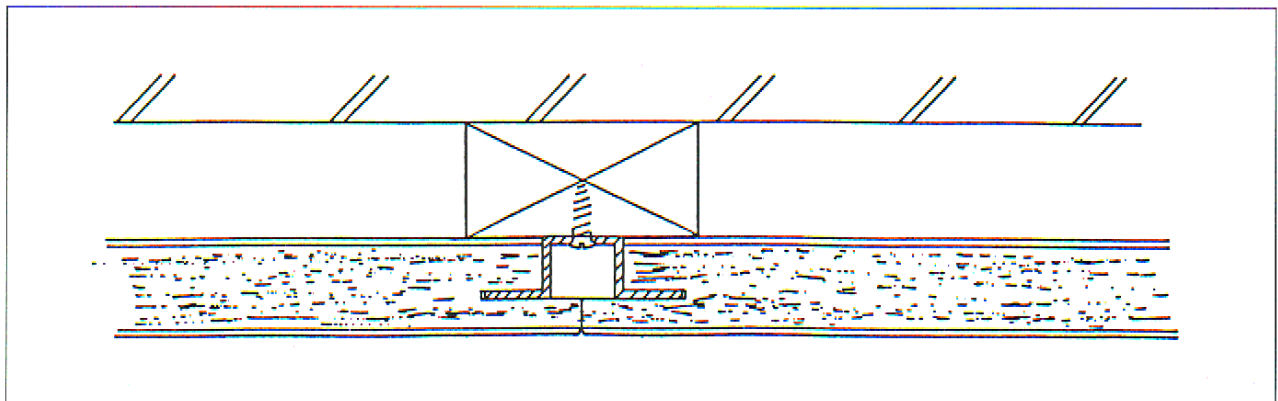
Omega-Profil, mit Nut und Falz in die Fugenkante eingelassen und auf Unterkonstruktion verschraubt; dichte Fuge
